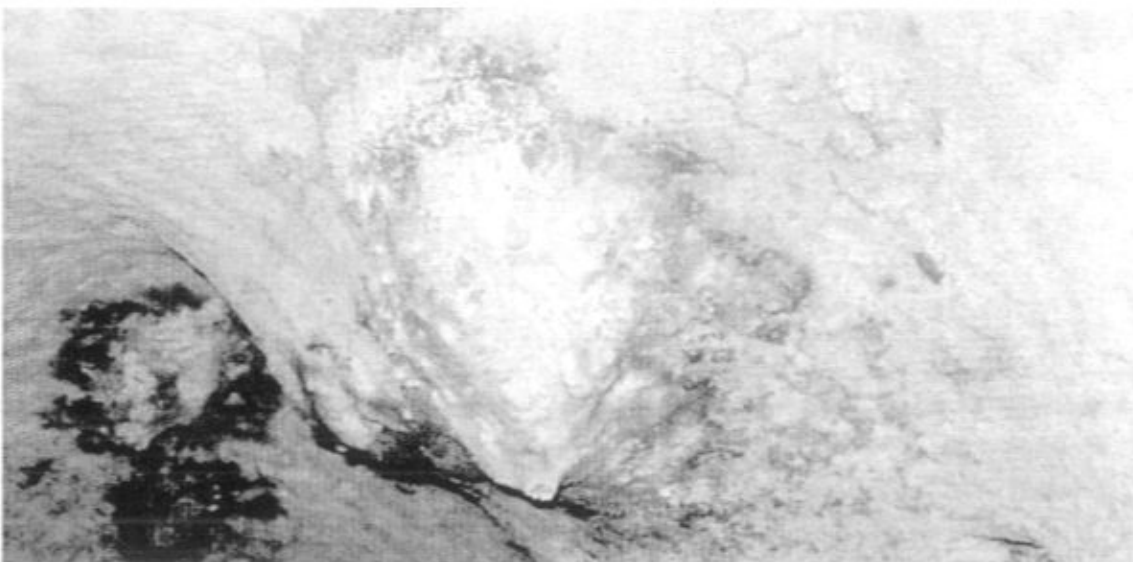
Particolare delle concrezioni calcaree.
